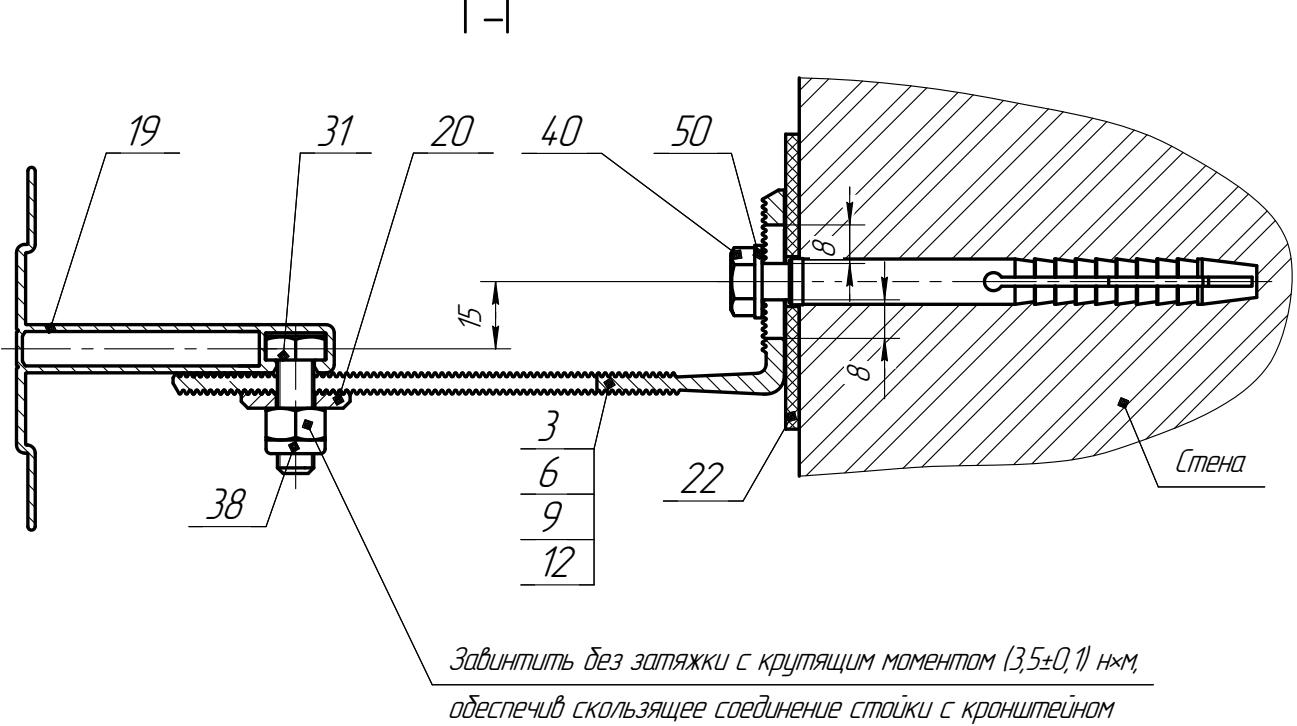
Узел закрепления стойки на опорном кронштейне к стене.
